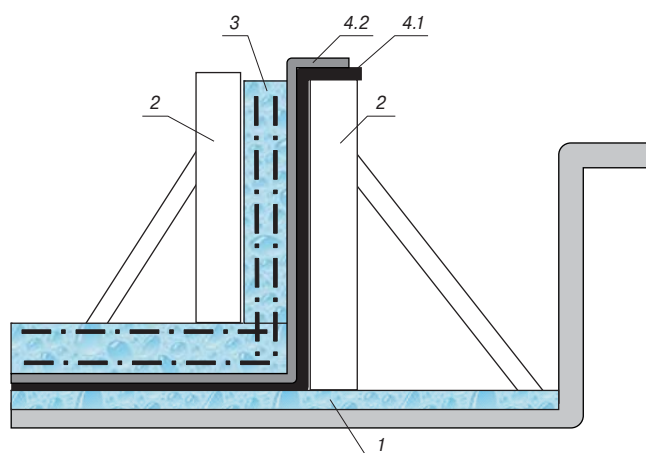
Схема подготовки бетонного фундамента с гидроизоляцией ЭПИКРОМом к заливке бетонной смеси в опалубку: 1 – бетонное основание; 2 – опалубка; 3 – бетонная смесь; 4.1 – предварительно склеенный в крупноборный изоляционный ковер ЭПИКРОМ; 4.2 – дублирующий нетканый материал
